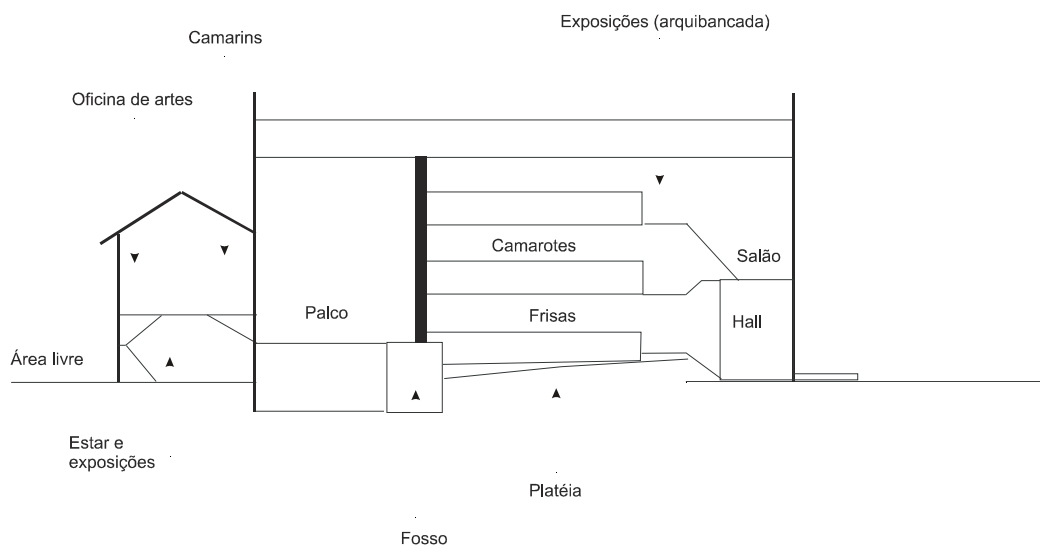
Croqui da organização interna teatro. Fonte : Arquivo do autor.
